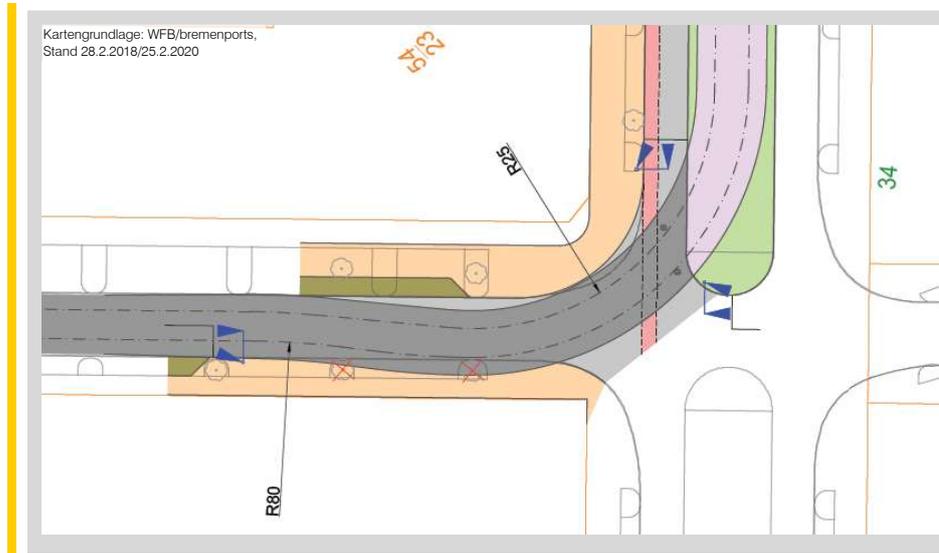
Ausschnitt Lageplan Abzweig vom K.-Johnsen-B. in K.-Ziegenbein-Allee
